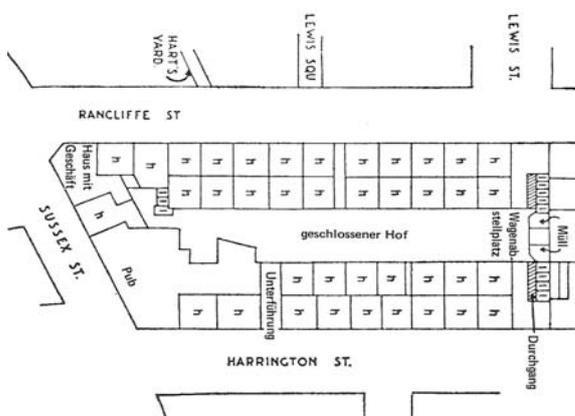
Back to Back Lageplan, 1845 Nottingham (l)
